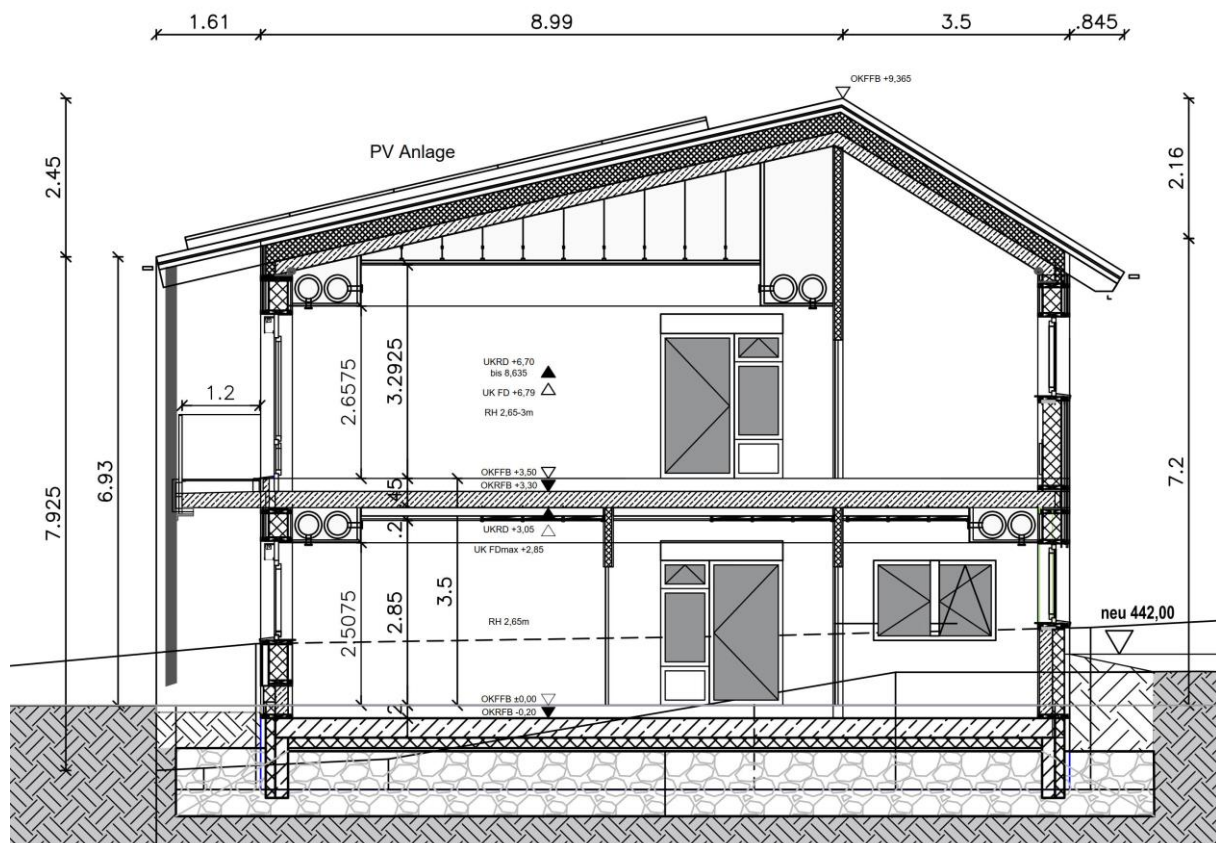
Schnitt Schema Mehrzweckraum [Quelle: Dr.-Ing. Stefan Hajek, Architekt und Stadtplaner]
